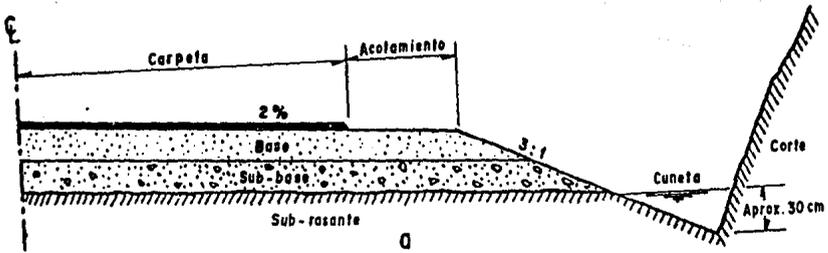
Disposición más conveniente de la cuneta, respecto al pavimento. Sección en corte, sin subdrenaje.
